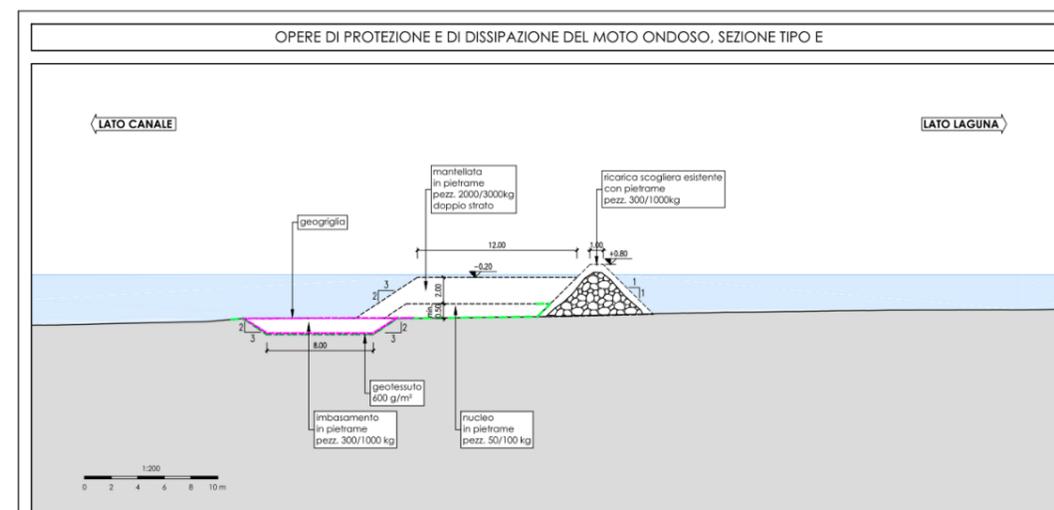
opere di protezione e dissipazione sezione tipo E
